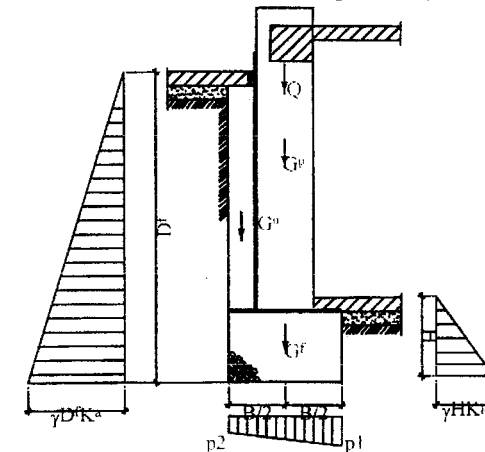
Schema de calcul pentru fundațiile pereților de subsol
